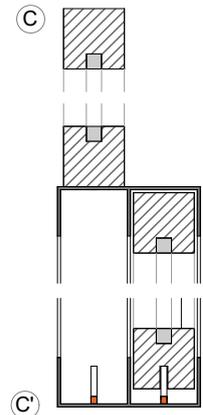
Pormenor construtivo vertical de C a C' - 1/5
